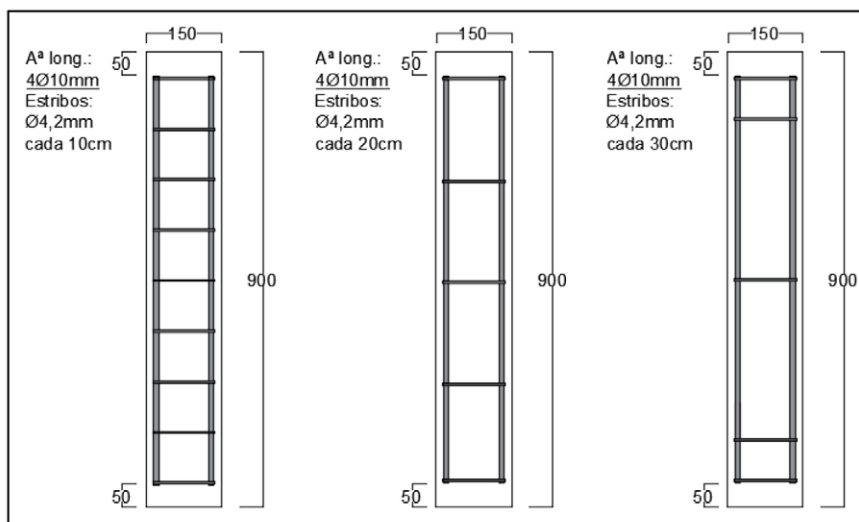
Detalle de armaduras longitudinal y transversal de columnas.
